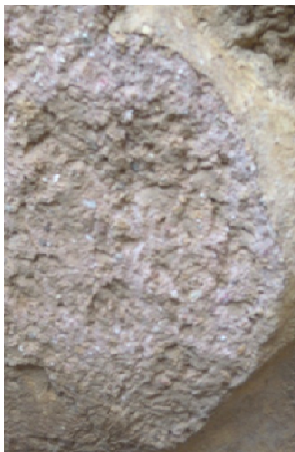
Placa de enlucido sin grieta interior aparente
